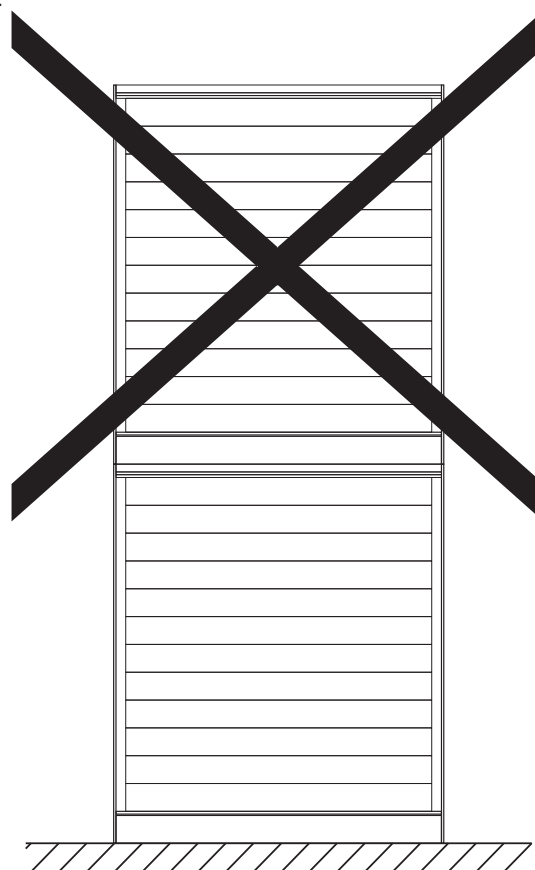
Запрещенное складирование панелей на строительной площадке.
